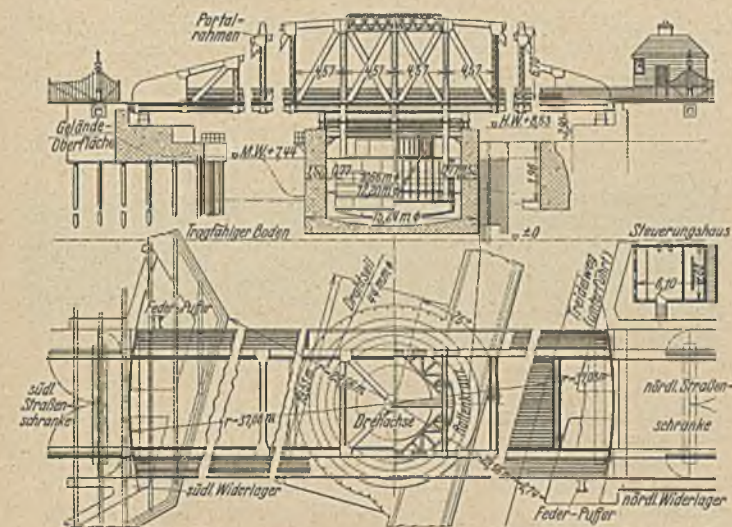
Die Drehbrücke über den Weaver-Fluß bei Acton Bridge. (Schematische Ansicht und Grundriß.)
